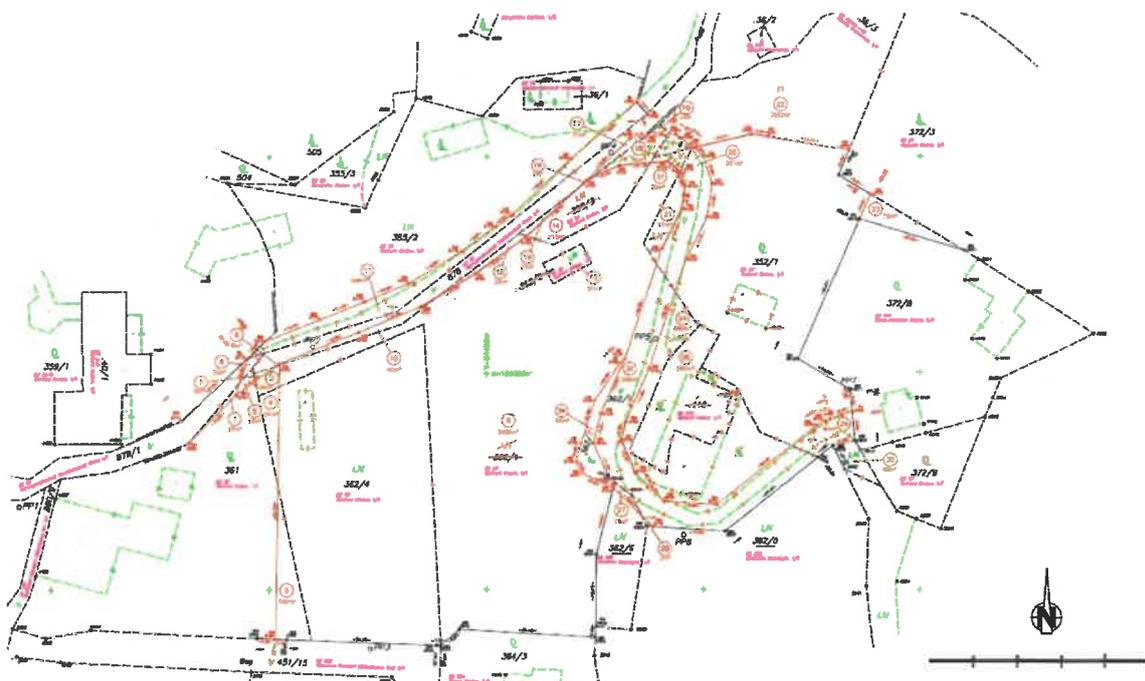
Lageplan Vermessung (Quelle: Angst Geo Vermessung ZT GmbH)
